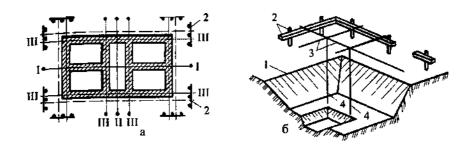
Схема разбивки котлована: а — схема разбивки котлована; б — схема обноски; I-I, II-II — главные оси здания; III — оси стенздания; 1 — границы котлована; 2 — обноска; 3 — проволка (причалка); 4 - отвесы
